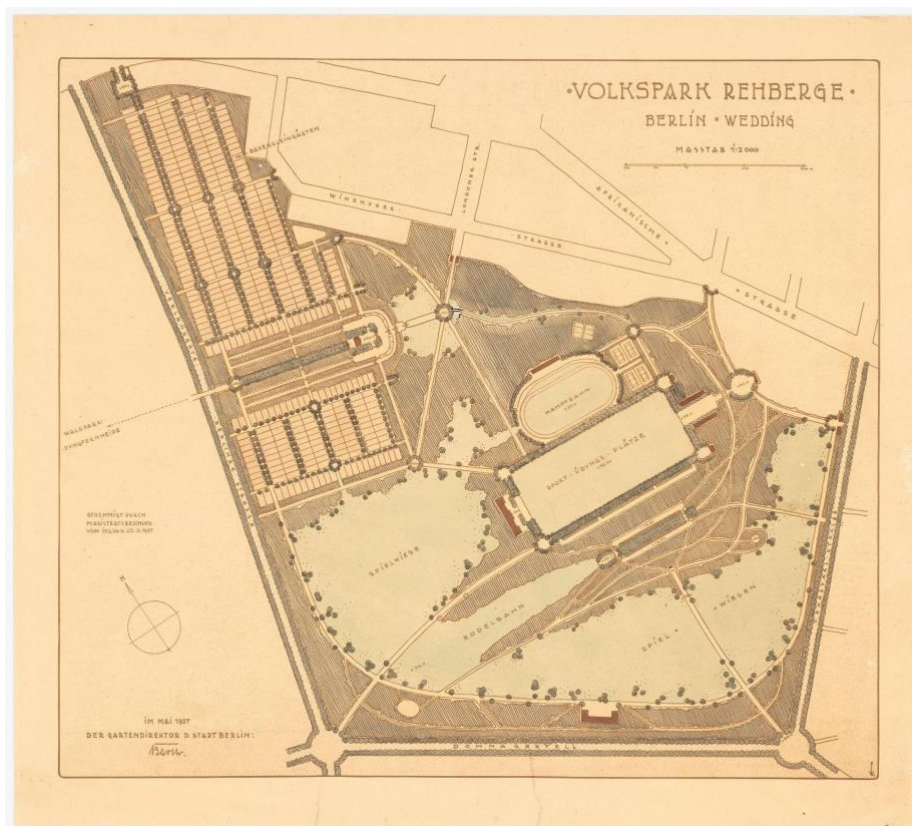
Plan des Parks Rehberge von 1927, Quelle: Erwin Barth, Volkspark Rehberge Gesamtanlage im Grundriss, 1927
